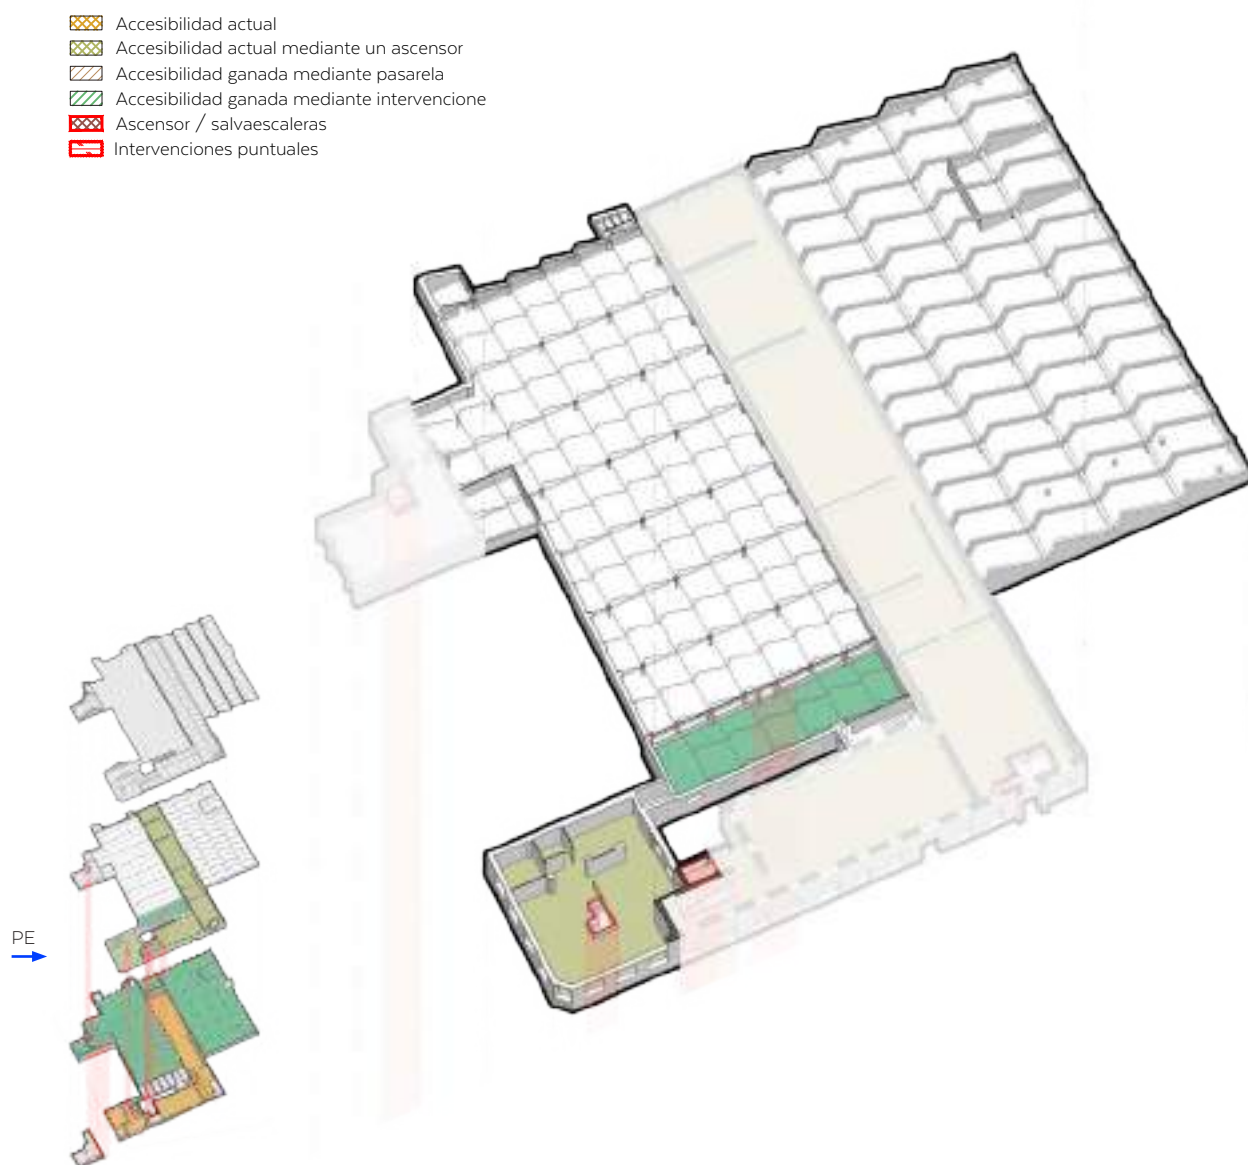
Accesibilidad propuesta. Axonometría de la entreplanta
